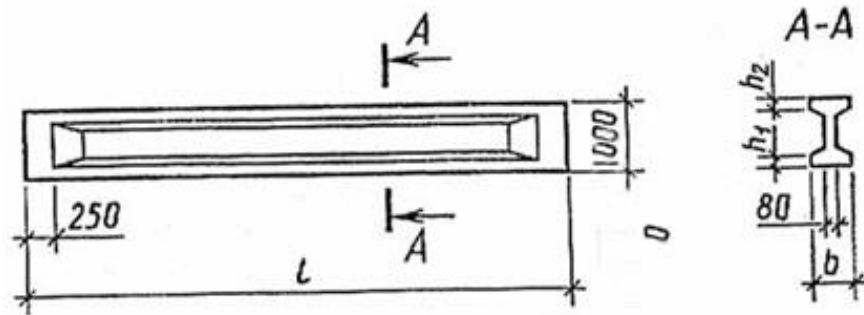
Проектована збірна залізобетонна балка двотаврового перерізу
